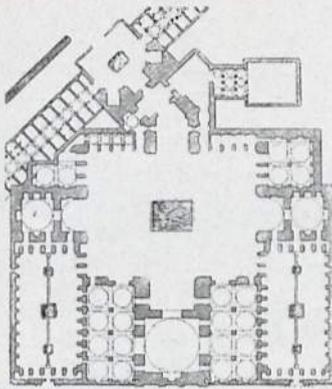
Grundriß der Meschidi-Schah in Ispahan. Nach Dieulafoy
